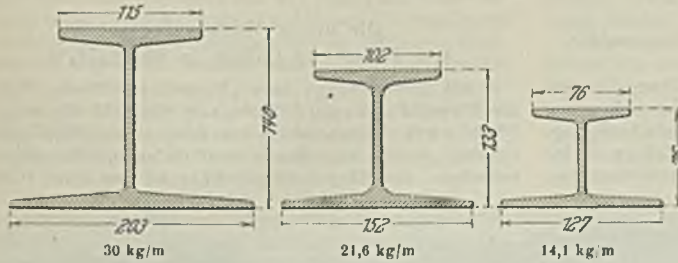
Querschnitt der Carnegie-Schwellen.
